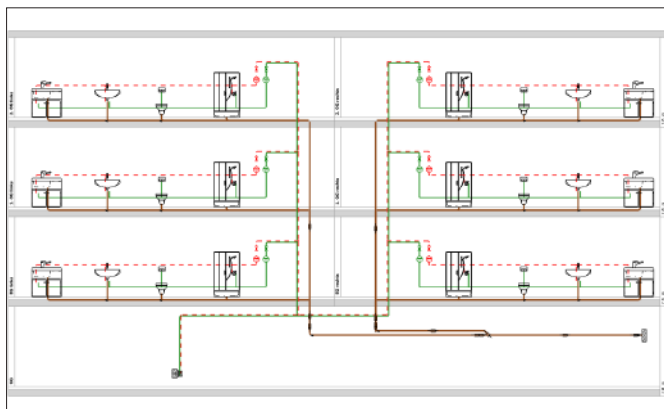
Planung einer Trinkwasserinstallation im Strangschema
